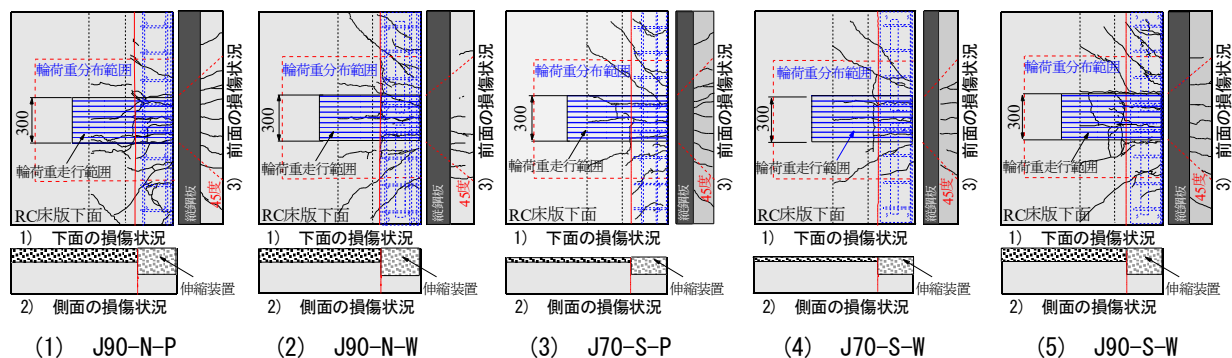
たわみが4.0mmに達した時点のひび割れ状況
